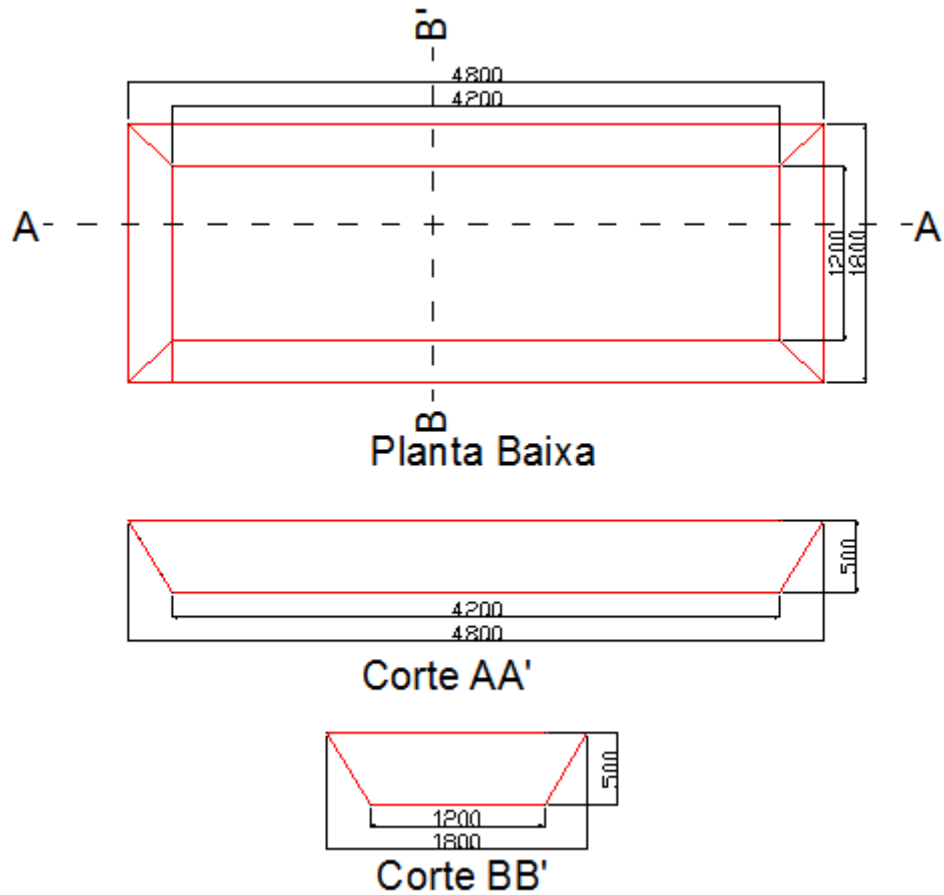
Planta baixa, perfil longitudinal e transversal do biodigestor
